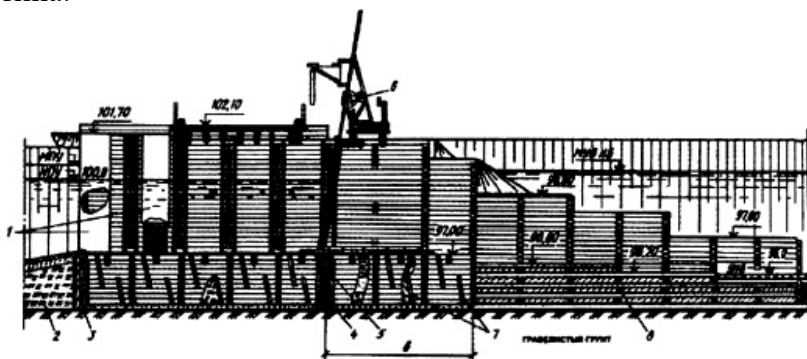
Продольный разрез по плотине с ряжевым флютбетом: 1 — обшивка врубок листовой сталью; 2 — битумный мат; 3 — шпунтовая стенка; 4 — сжимы; 5 — направляющий треугольник; 6 — ручной передвижной реечный подъемник; 7 — шпонки; 8 — сквозные ряжи.
